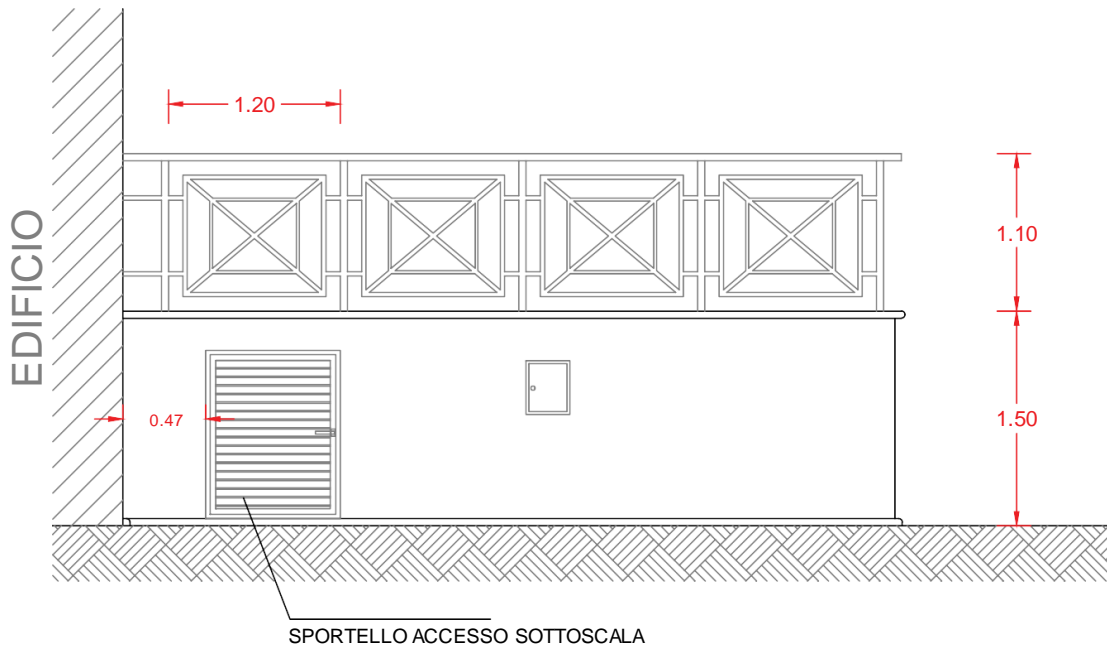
planimetria e sezione della posizione dove installare la piattaforma per disabili.
